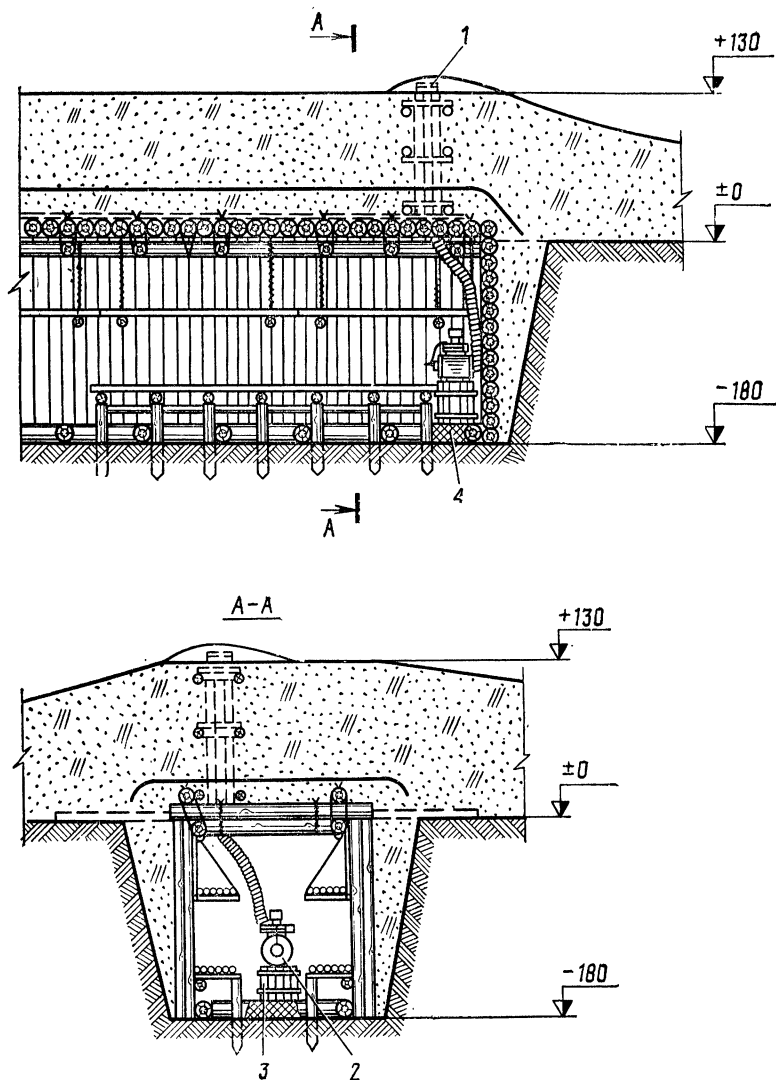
Монтаж ФВА-50/25 в убежище безврубочной конструкции:
